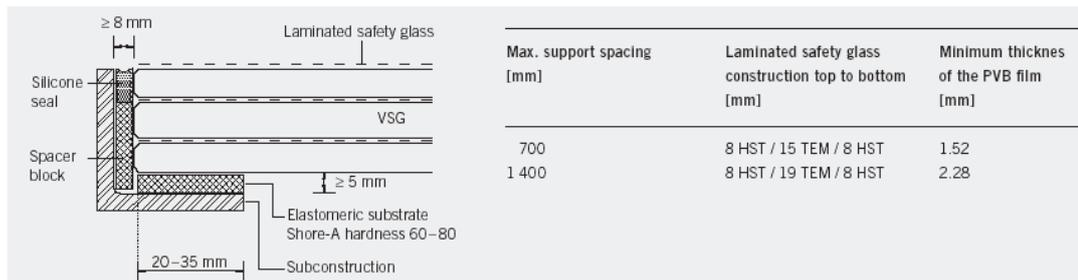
Tampak samping potongan stuktur lantai kaca laminasi
